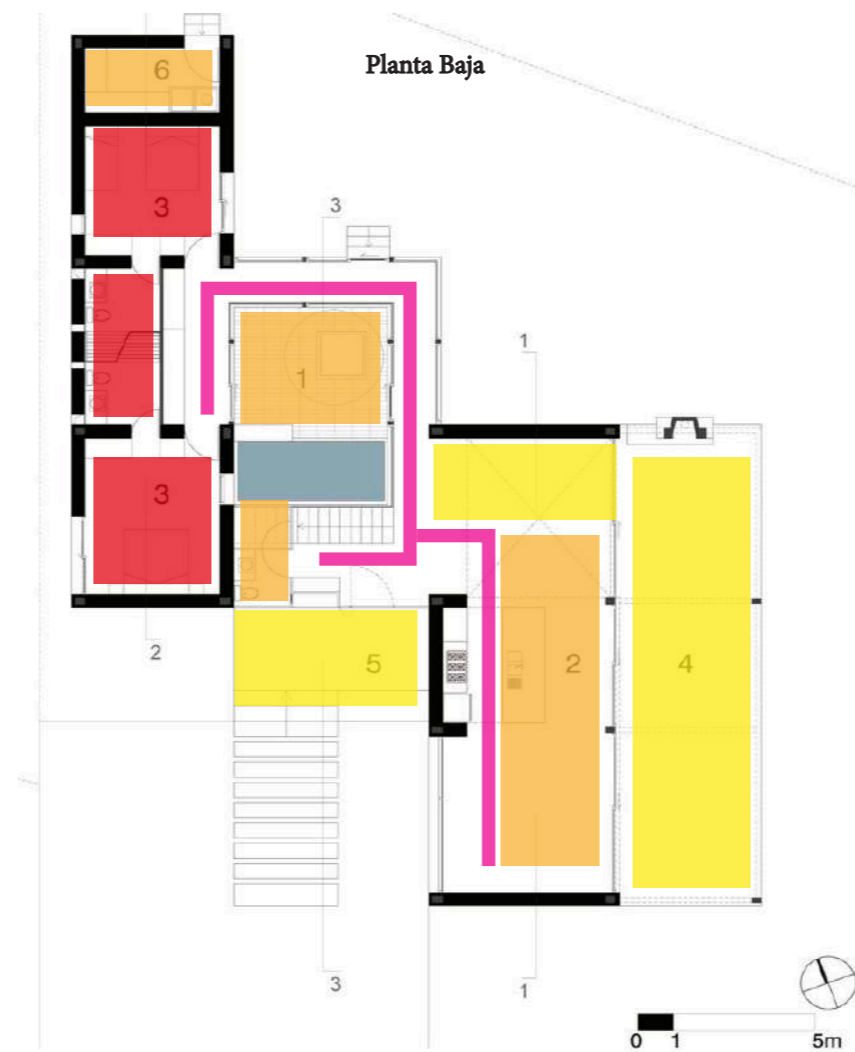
Casa en Cotacachi- análisis funcional planta baja
